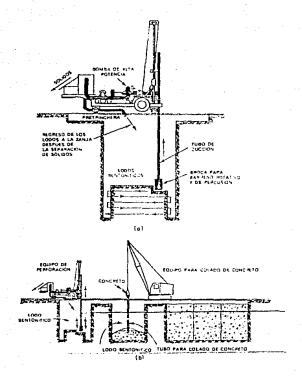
CONSTRUCCION DE MURO MILAN
